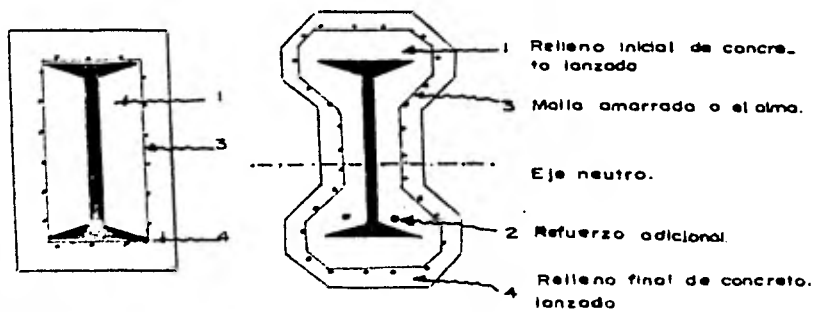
Reparación en vigas de acero, empleando concreto lanzado.
